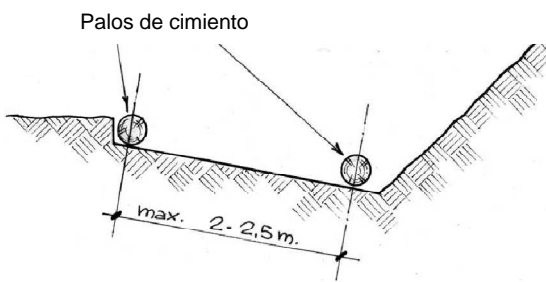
d – Excavación del piso de cemento con pendiente de 5-15° hacia dentro
